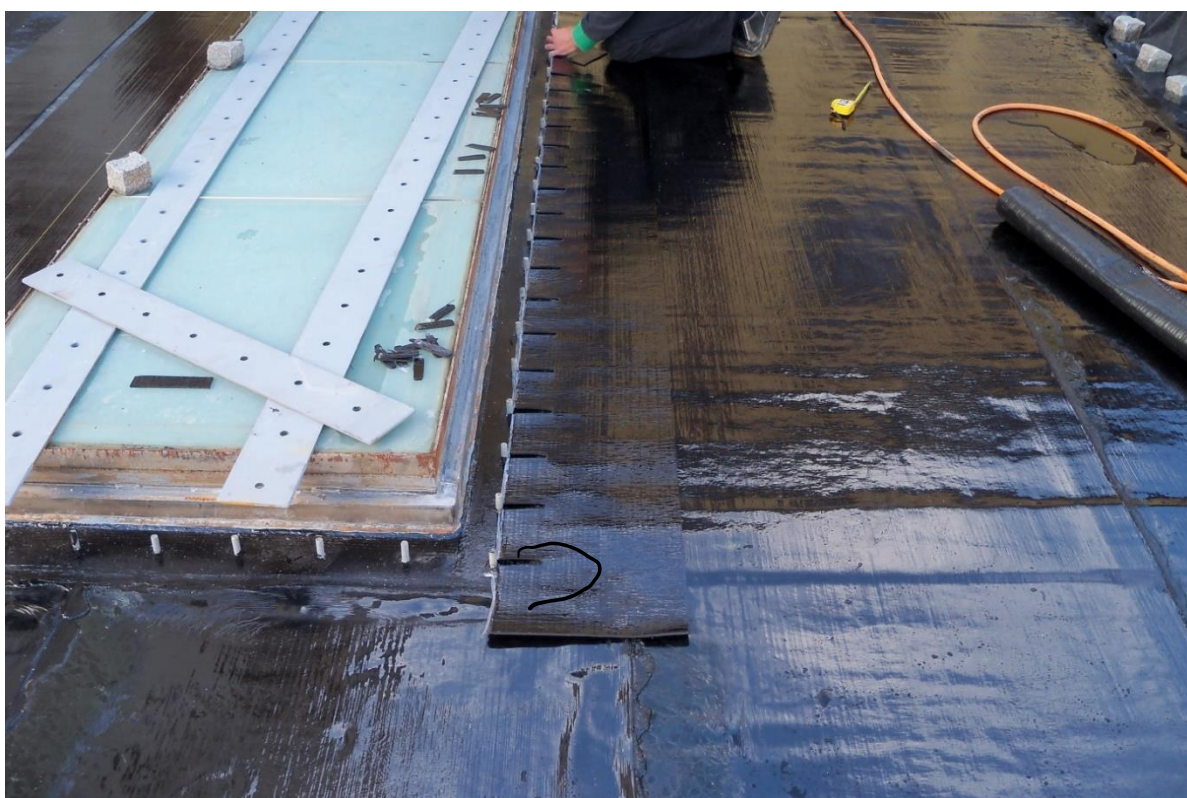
Detail pevné příruby, připravené pro osazení hydroizolace
